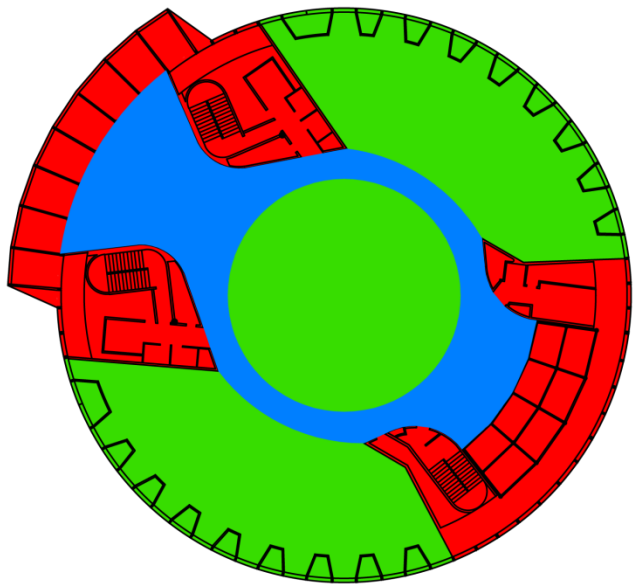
Análisis de Área Usable, Planta tipo Tour Sans Fins.
